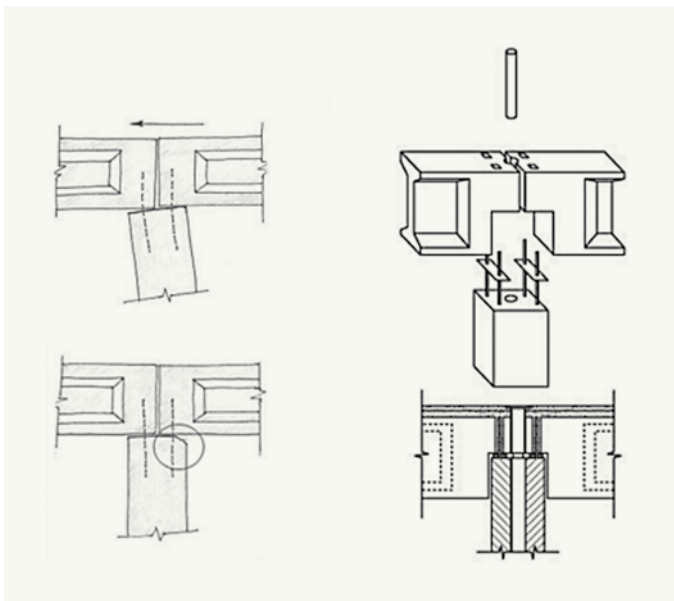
Encuentros pilar intermedio - vigas principales.
